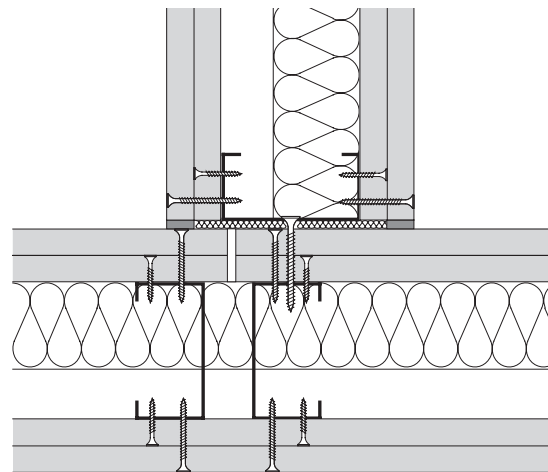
Schalltechnisch richtiger Bauteilanschluss mit dichtem Wandanschluss und Trennung der flankierenden Beplankung
